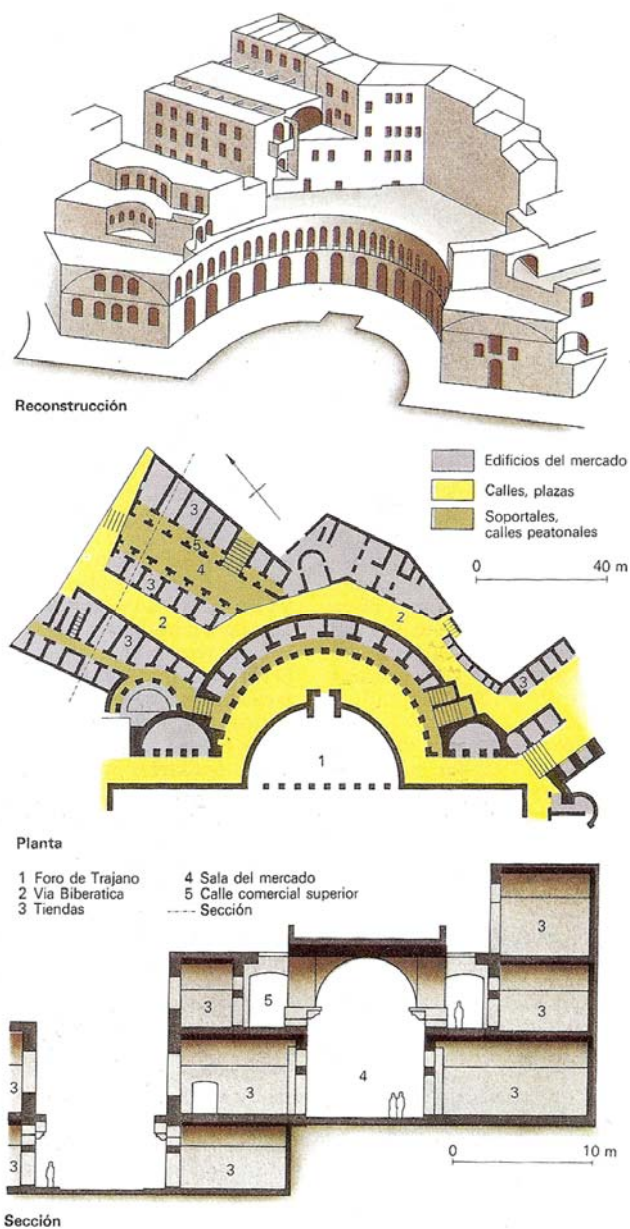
Fórum de Trajano - Reconstituição perspéctica (em cima), planta (ao centro) e perfil (em baixo)
